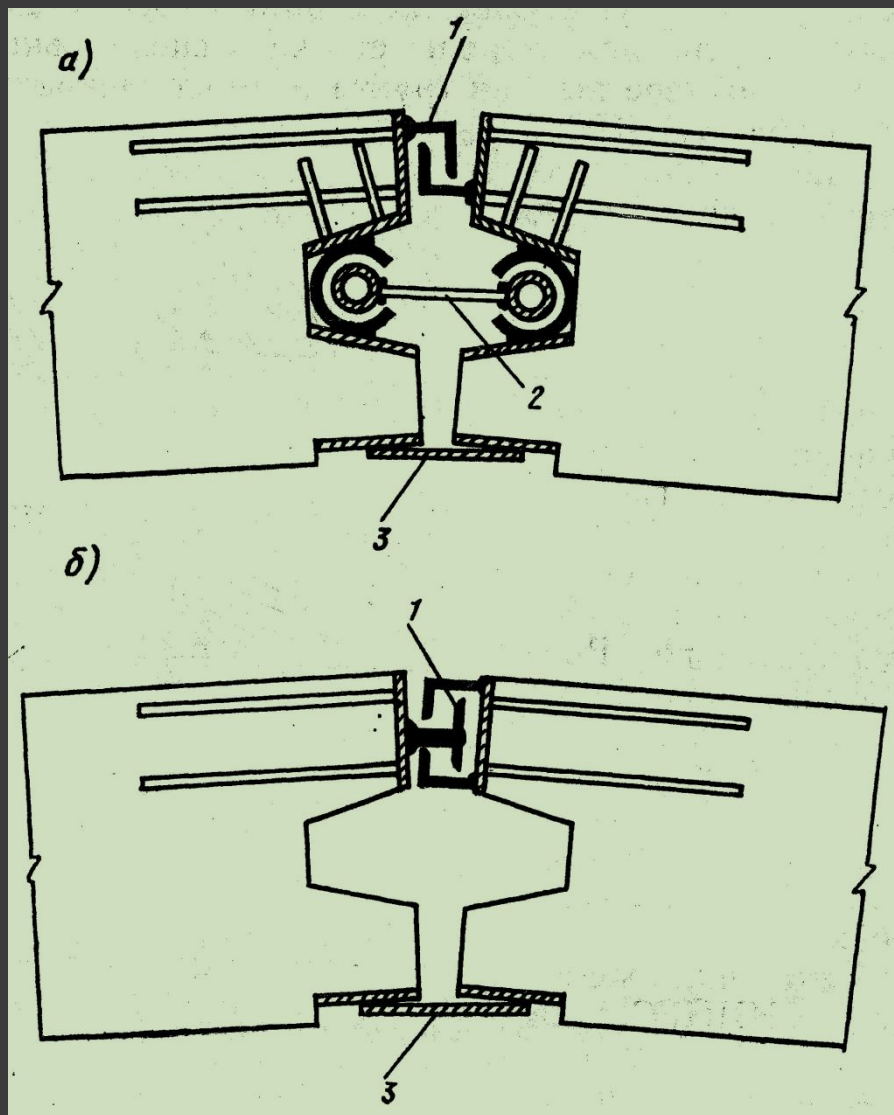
Стены в грунте из сборных элементов с жестким стыком смежных панелей (конструкции ВНИИГС)
